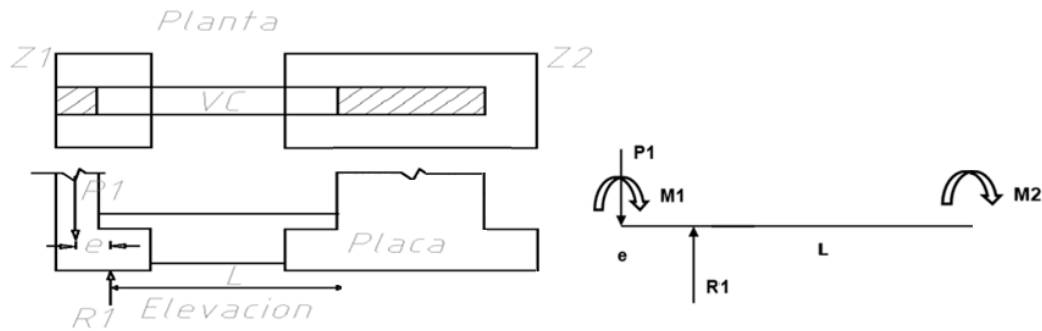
Vista de elevación, elevación y modelo estructural de la zapata conectada.
